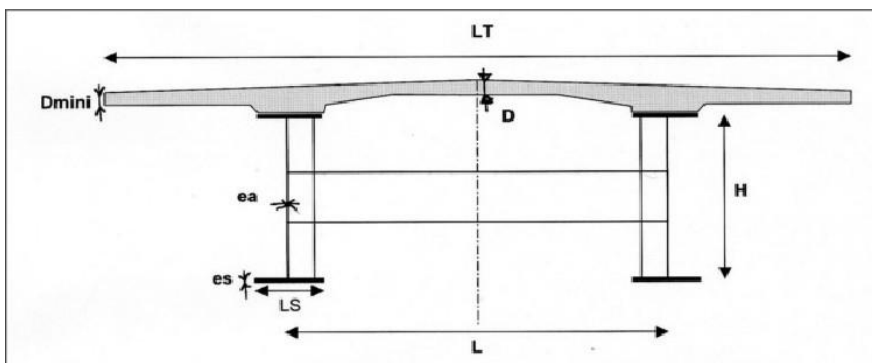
Paramètres du dimensionnement d'une bipoutre à entretoise.
